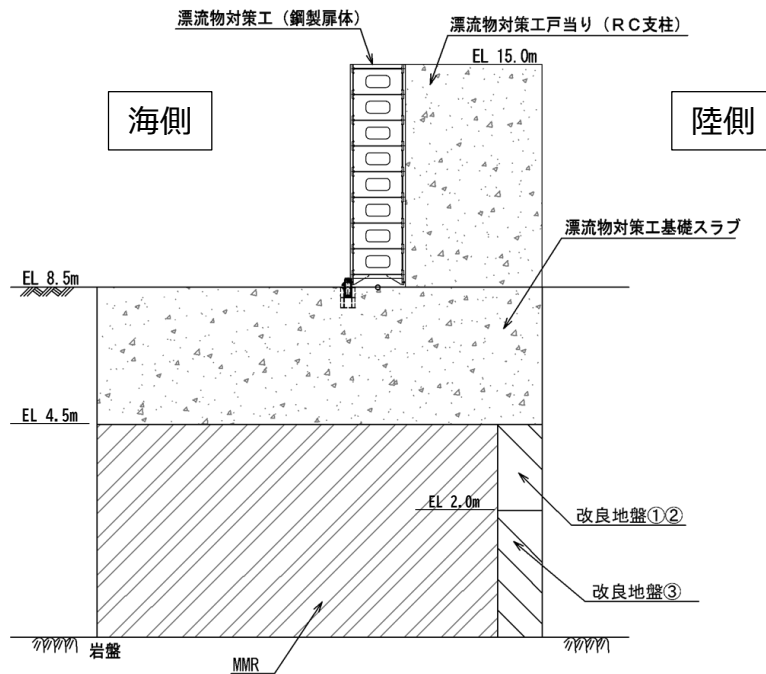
(2) 漂流物対策工の構造図(基礎断面図, C-C断面)
